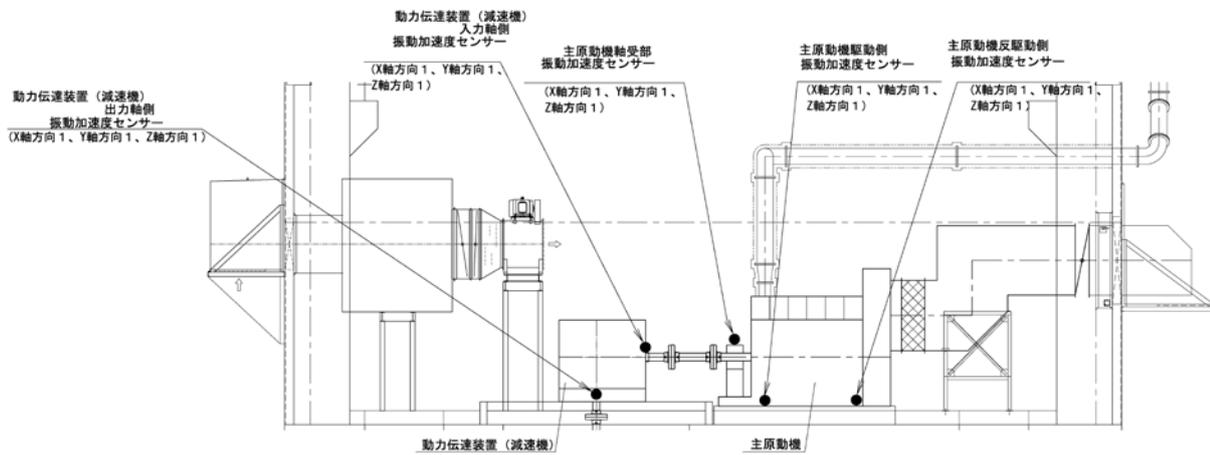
主原動機・減速機のセンサー取付位置図 (断面図)
